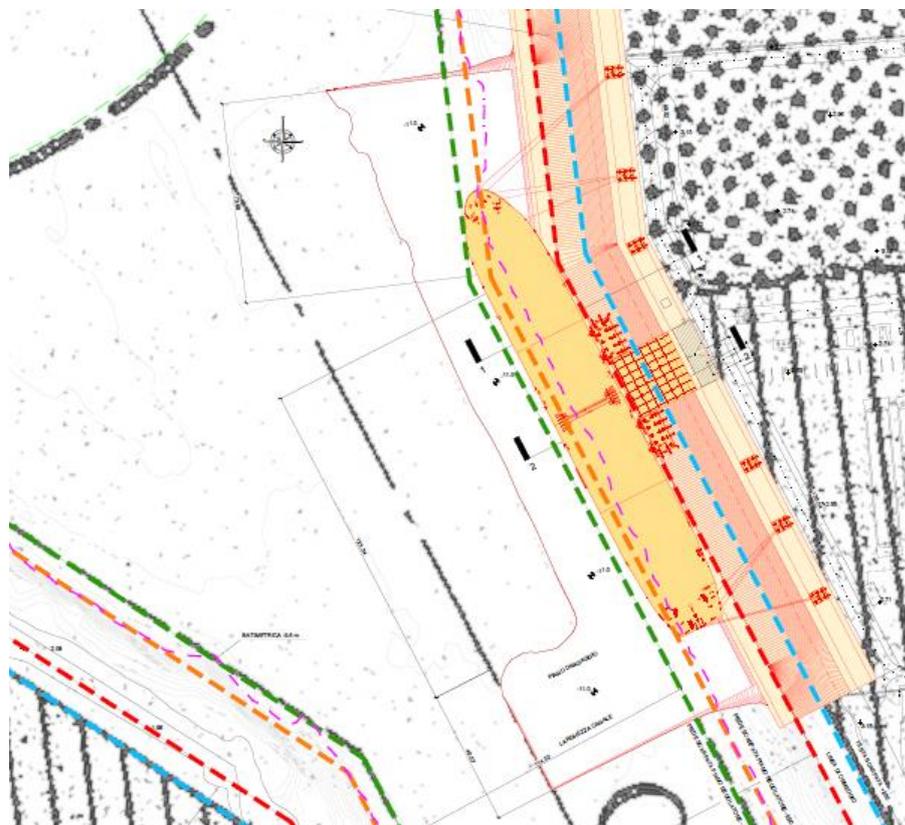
Opera a Mare sovrapposizione planimetria di progetto e ingombri Piano Regolatore Portuale
